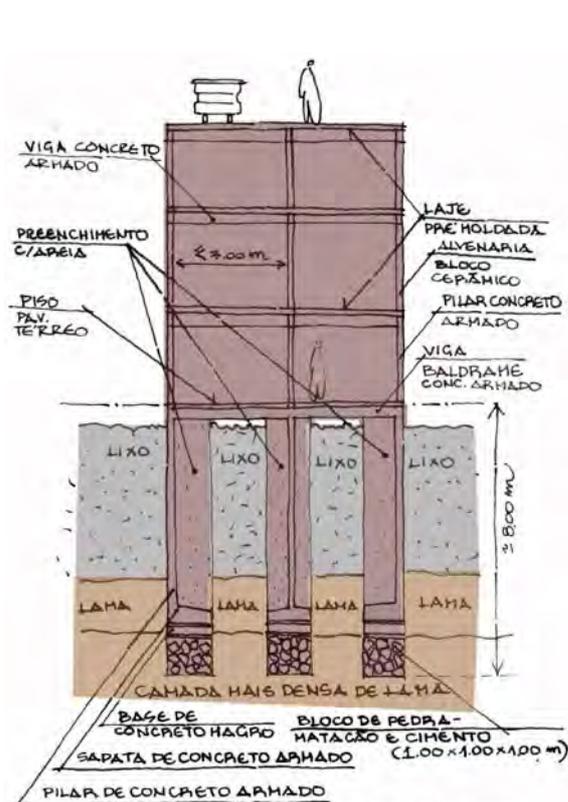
Salvador, Bahia, Alagados - sobrados das áreas consolidadas e semiconsolidadas - esquema construtivo - corte esquemático.
